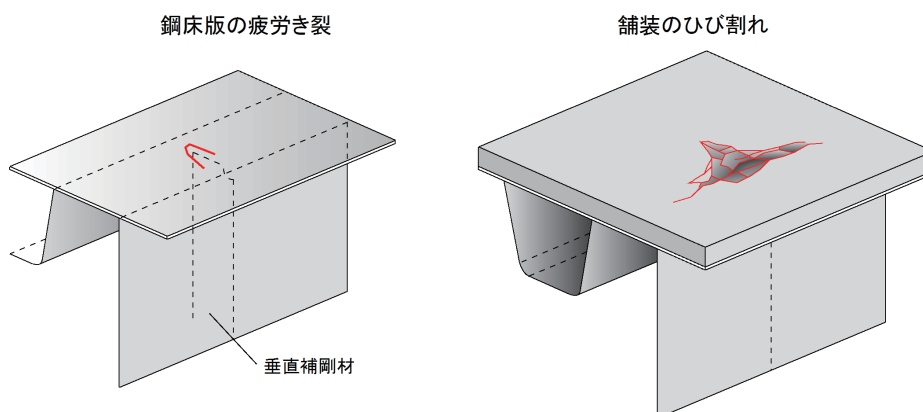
デッキプレート貫通き裂と舗装のひび割れ
